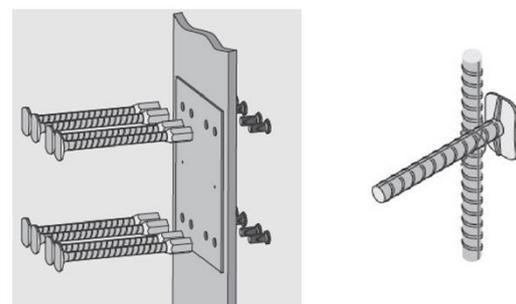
HSC-B Muffenstäbe mit Einbauschablone und Schrauben auf der Schalung befestigen, Muffenstäbe mit bauseitiger Bewehrung verrödeln
